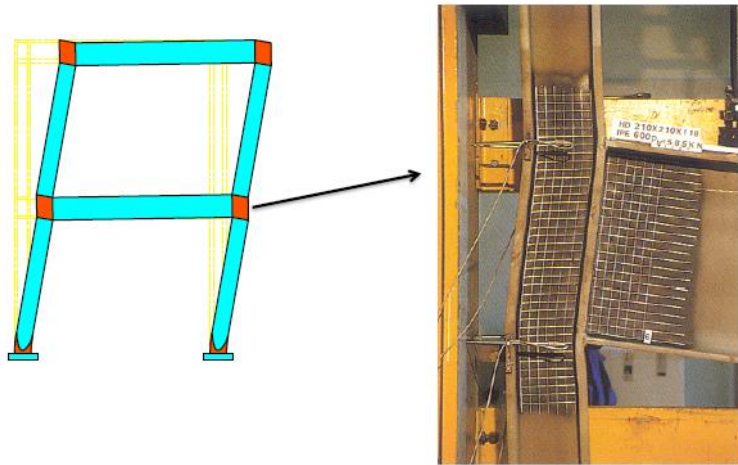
Plastificación a corte en el panel viga/columna de un SMFs de acero. (Suzuki & Lignos, 2017)
